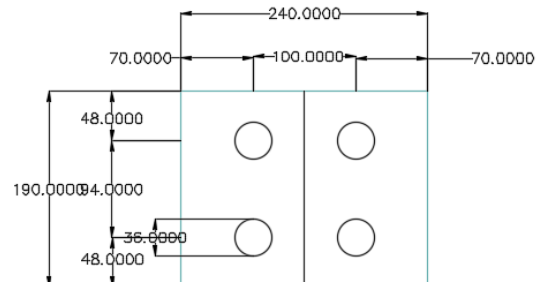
Pormenor da ligação dos pilares da fundação E às cordas inferiores da treliça
